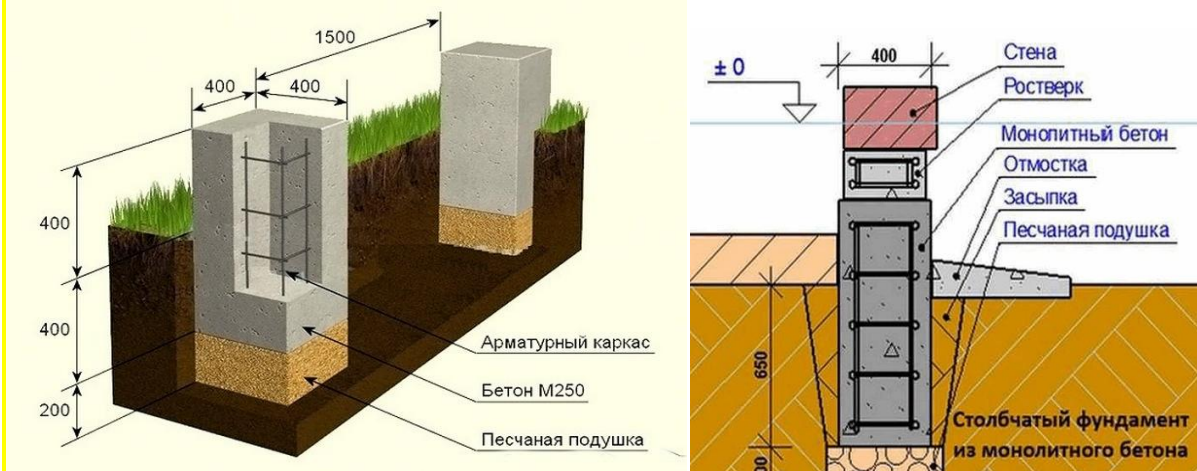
Узел монолитного столбчатого фундамента под наружную стену
